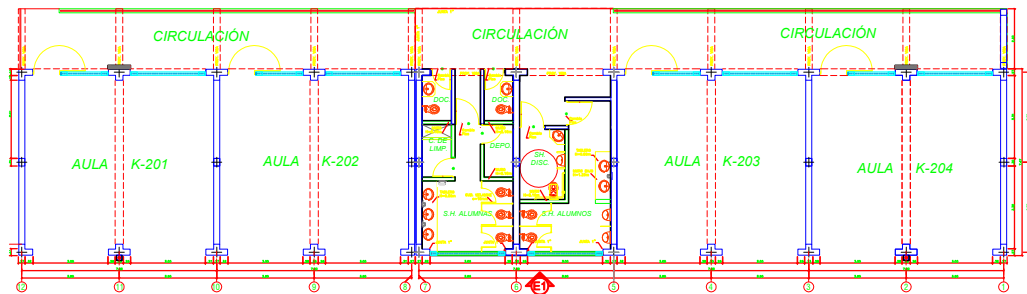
Planos Contractuales de Estructuras- Fuente:Propia
